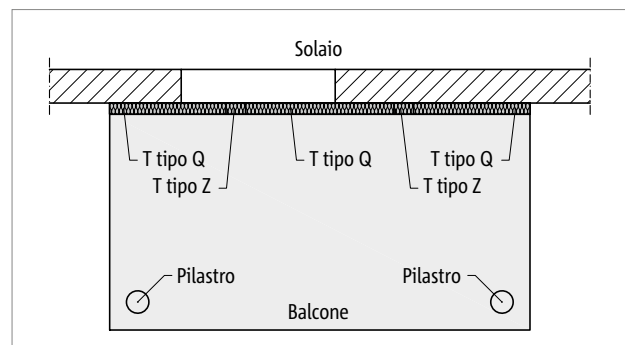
Schöck Isokorb® T tipo Z, K: balcone con appoggio su pilastri
